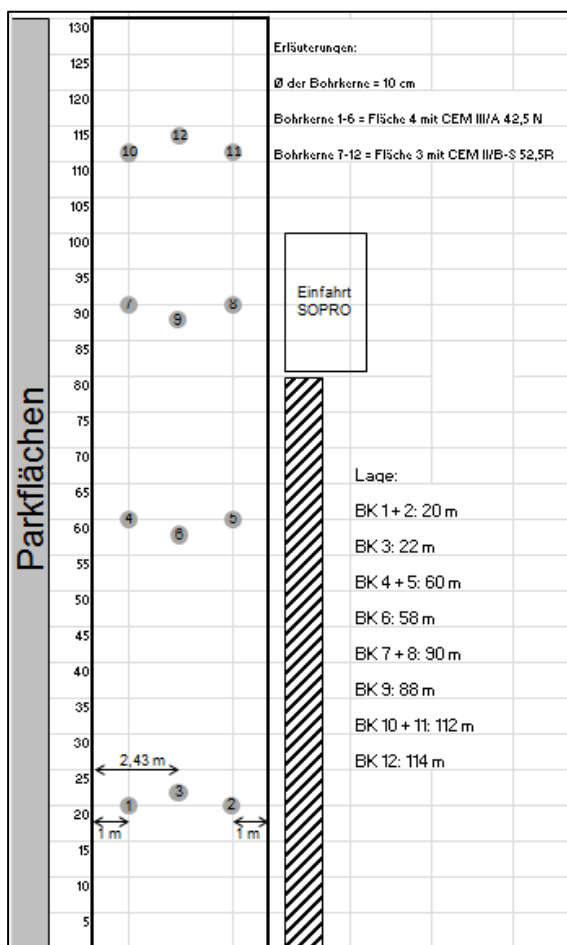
Lageplan der Bohrkerne (Anlage 1)
